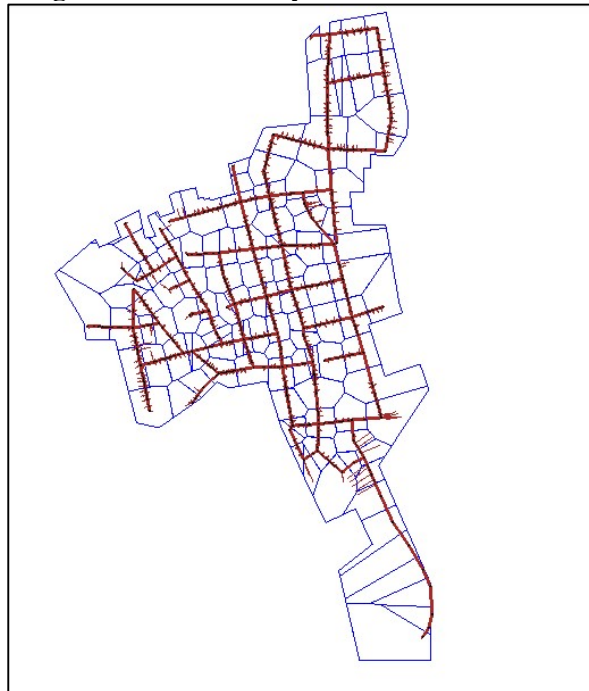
Red de alcantarillado del Distrito de Santa Rosa
